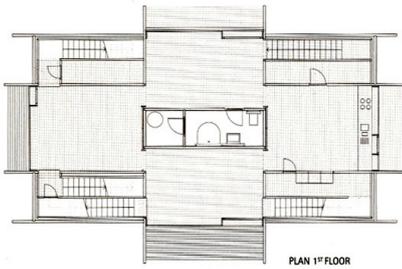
Planta de la vivienda, donde se distinguen las cinco torres estructurales.
